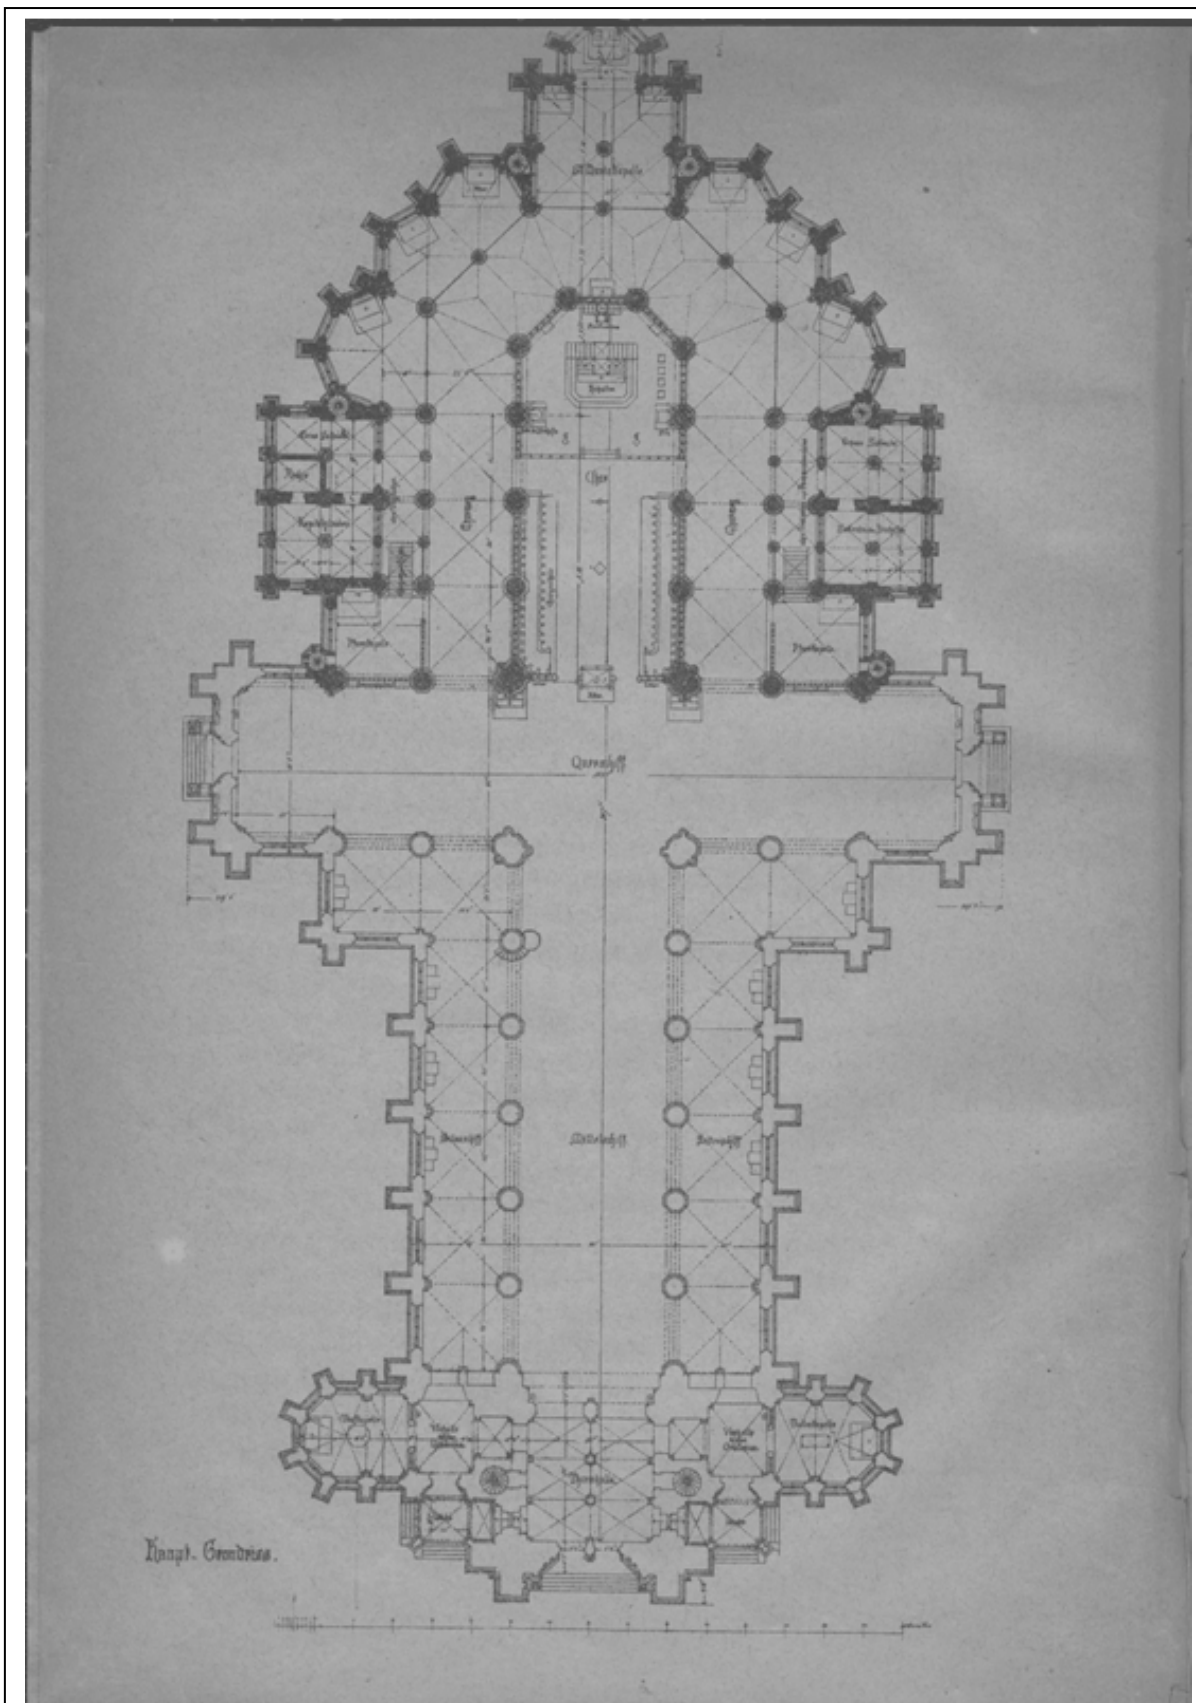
Haupt-Grundriss, wohl 1859
